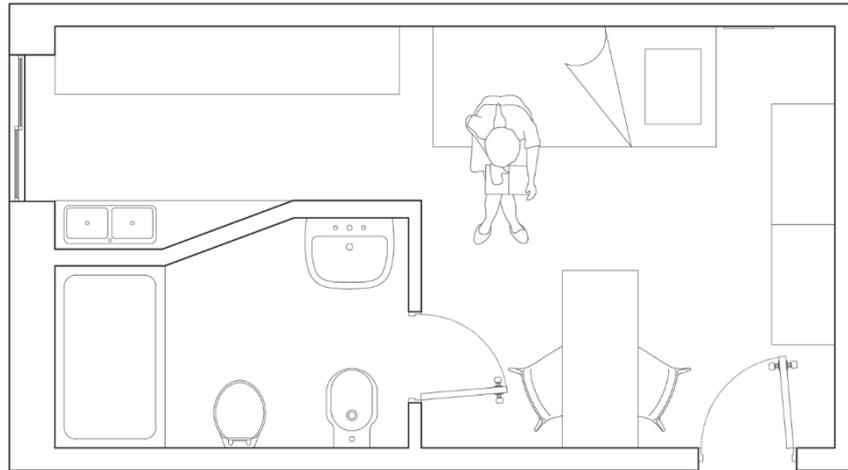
Planta mobiliario original caso de estudio. Escala 1:50. Fuente: elaboración propia.
